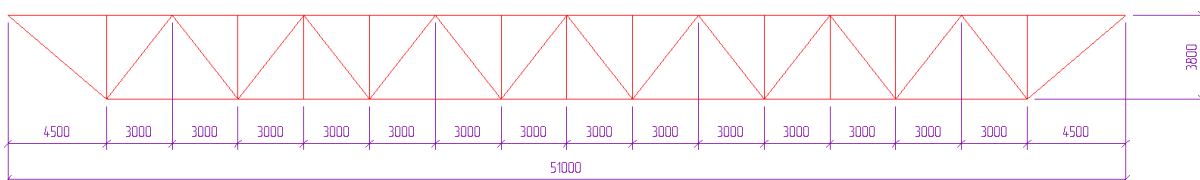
Расчетная схема стропильной фермы длиной 51 метров
